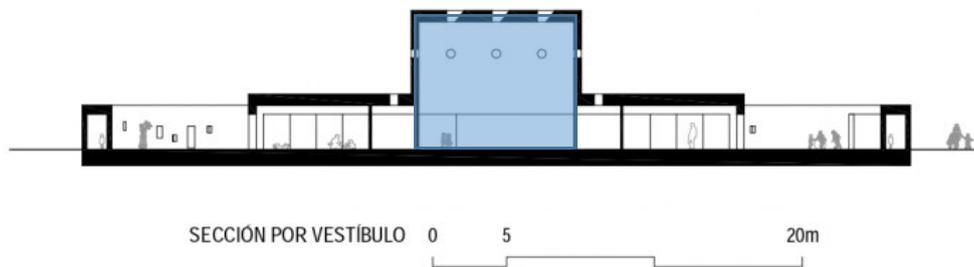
Las imágenes muestran la flexibilidad del espacio exterior de la Guardería para Benetton en Ponzano Véneto. Fuente: Sitio web de arquitectura ArchDaily Perú.
